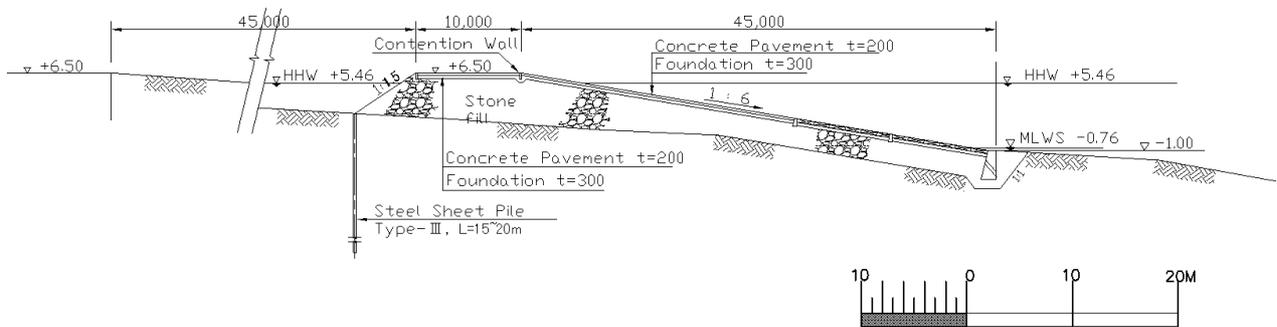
Sección Longitudinal Típica de Rampa
